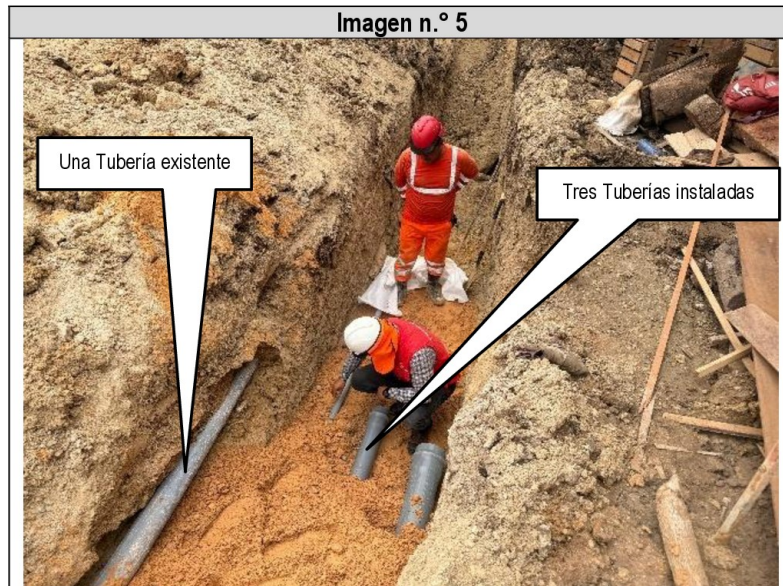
Tuberías instaladas en la zanja, de diámetros 38 mm, 110 mm y 160 mm. Tubería existente en pared de zanja.
